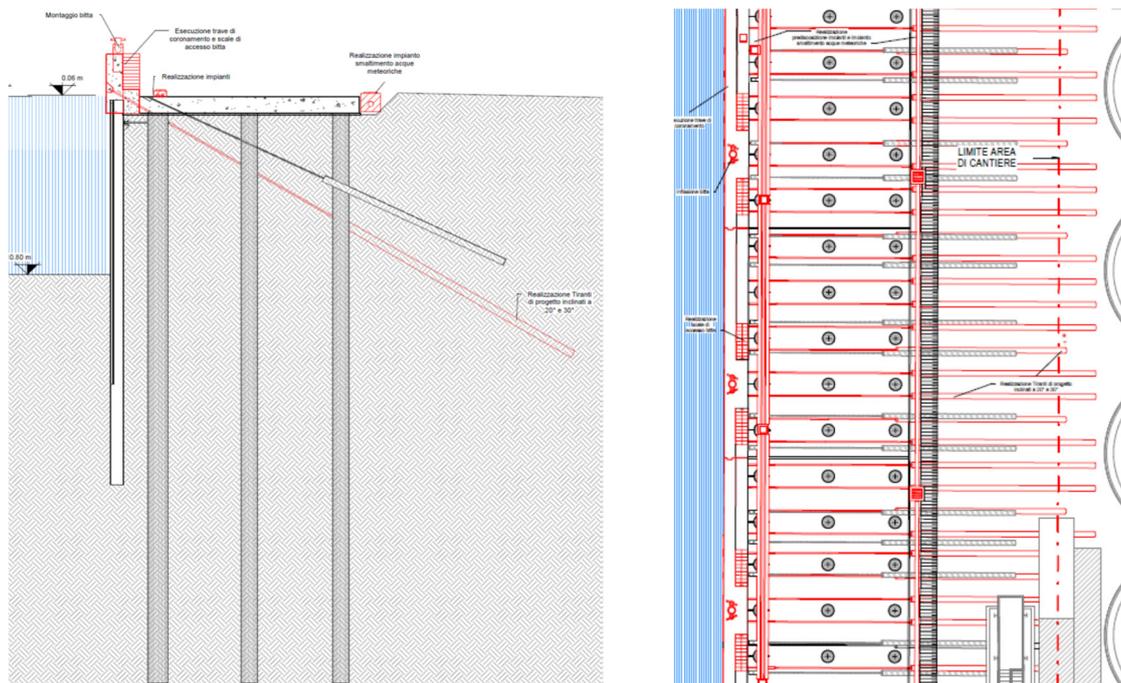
Banchina Bunge Sud – Fase 8 – Sezione e planimetria
